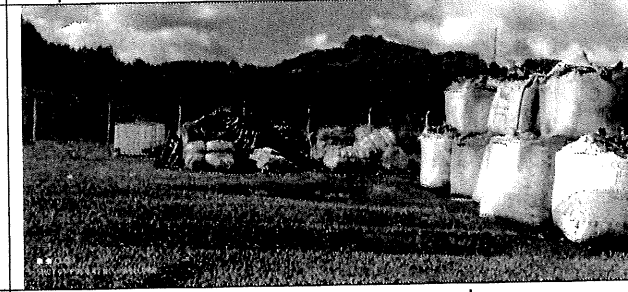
Cinzas e escoria armazenado no empreendimento.
